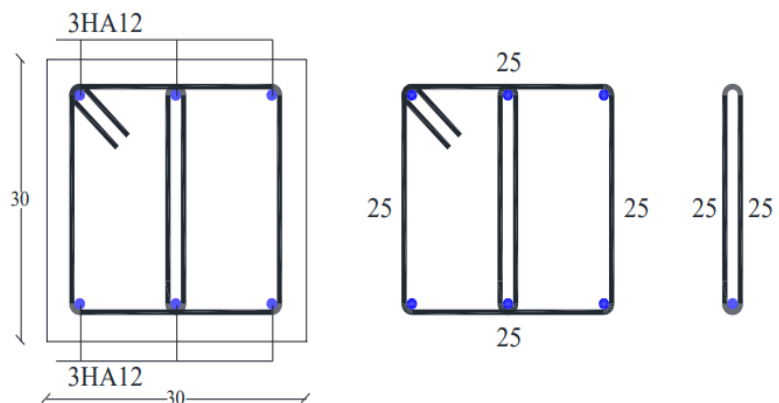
ferrailage de la section transversal du poutre palier
